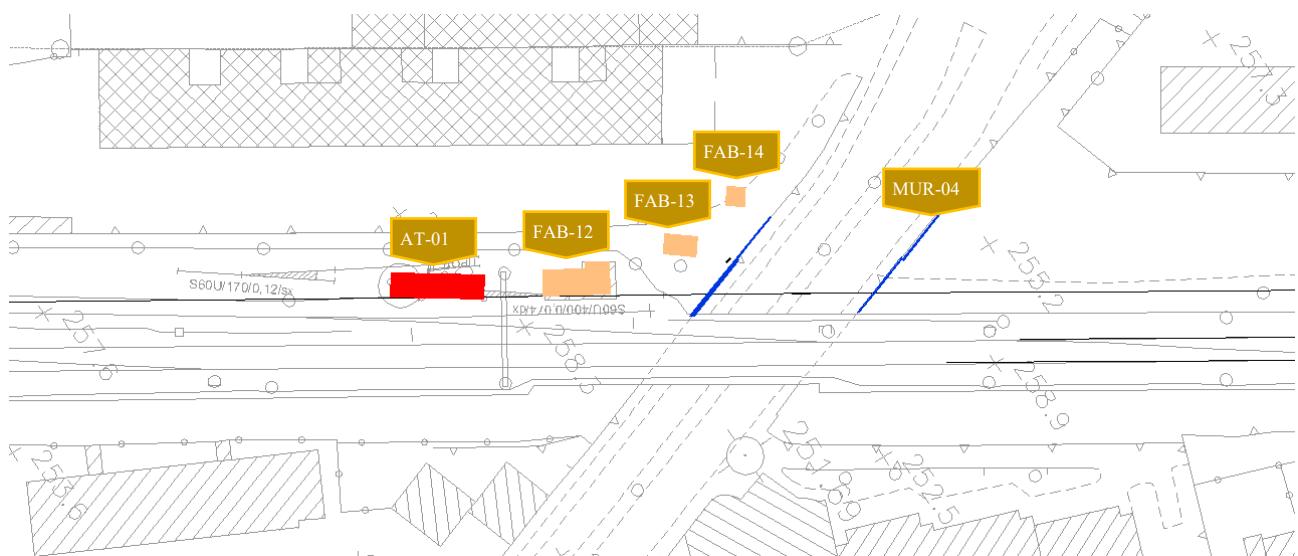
Stralcio planimetrico zona sottopasso via Roma
